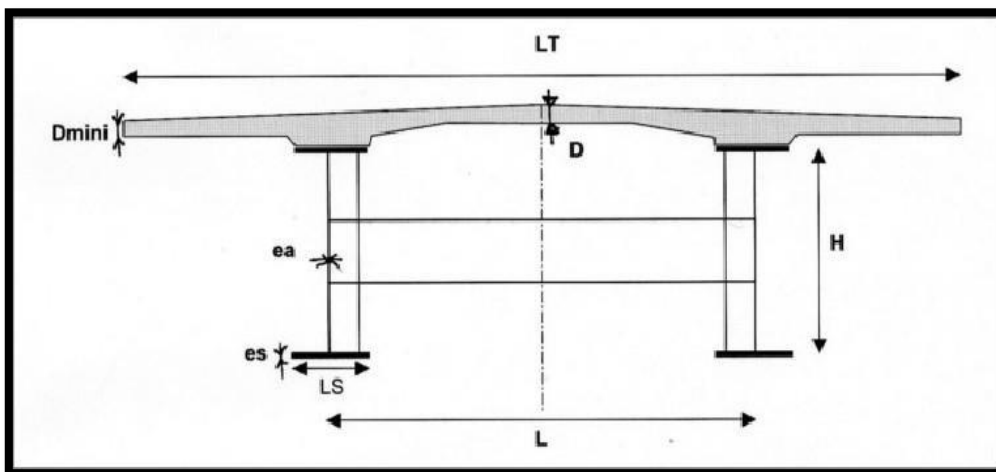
Paramètres du dimensionnement d'une bipoutre à entretoise.
